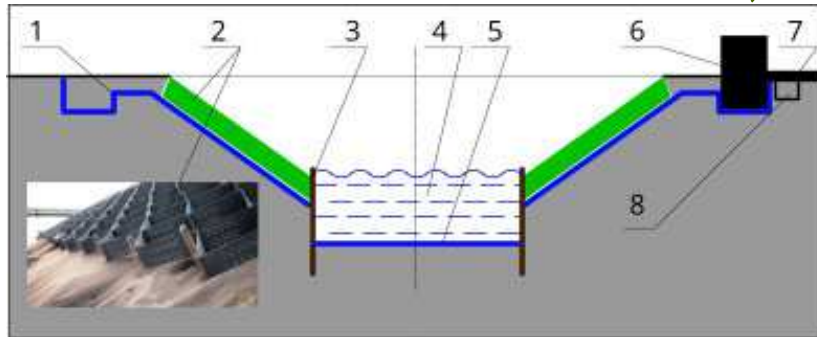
Кріплення берега: 1 – геотекстиль; 2 – георешітка із заповненням ґрунтом та суміш трав; 3 – шпунтове кріплення; 4 – русло; 5 – шар геотекстилю; 6 – бордюр; 7 – асфальтобетонне покриття; дренажна система
